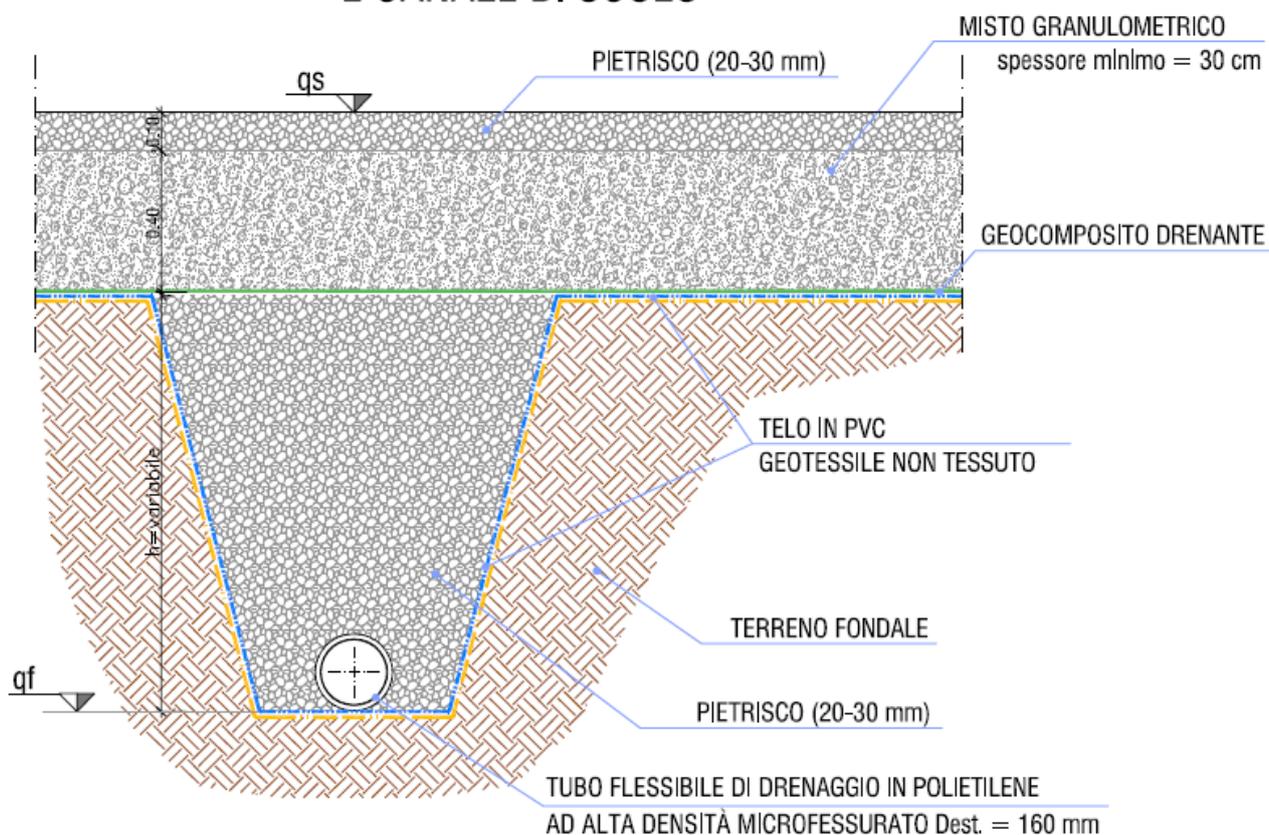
sezione impermeabilizzazione del piazzale di perforazione
